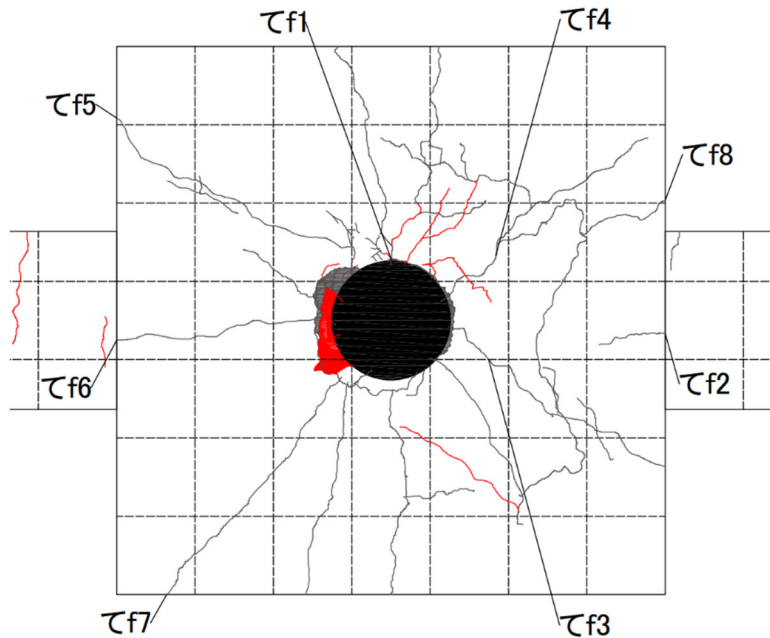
パイルキャップ底面ひび割れ幅測定位置 (試験体 DR-5 +7.0 サイクル)
